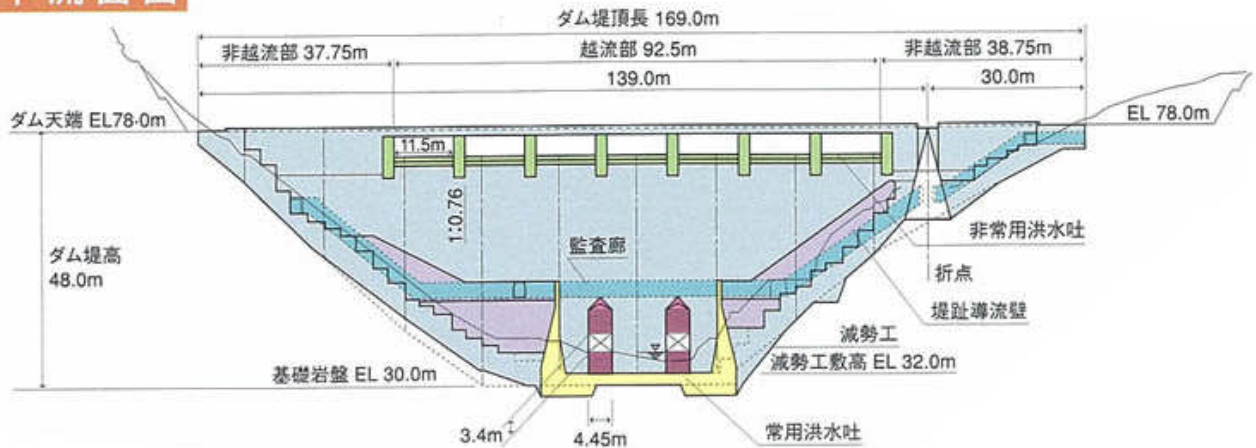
標準断面図・仕組み解説・下流面図<sup>24)</sup>
